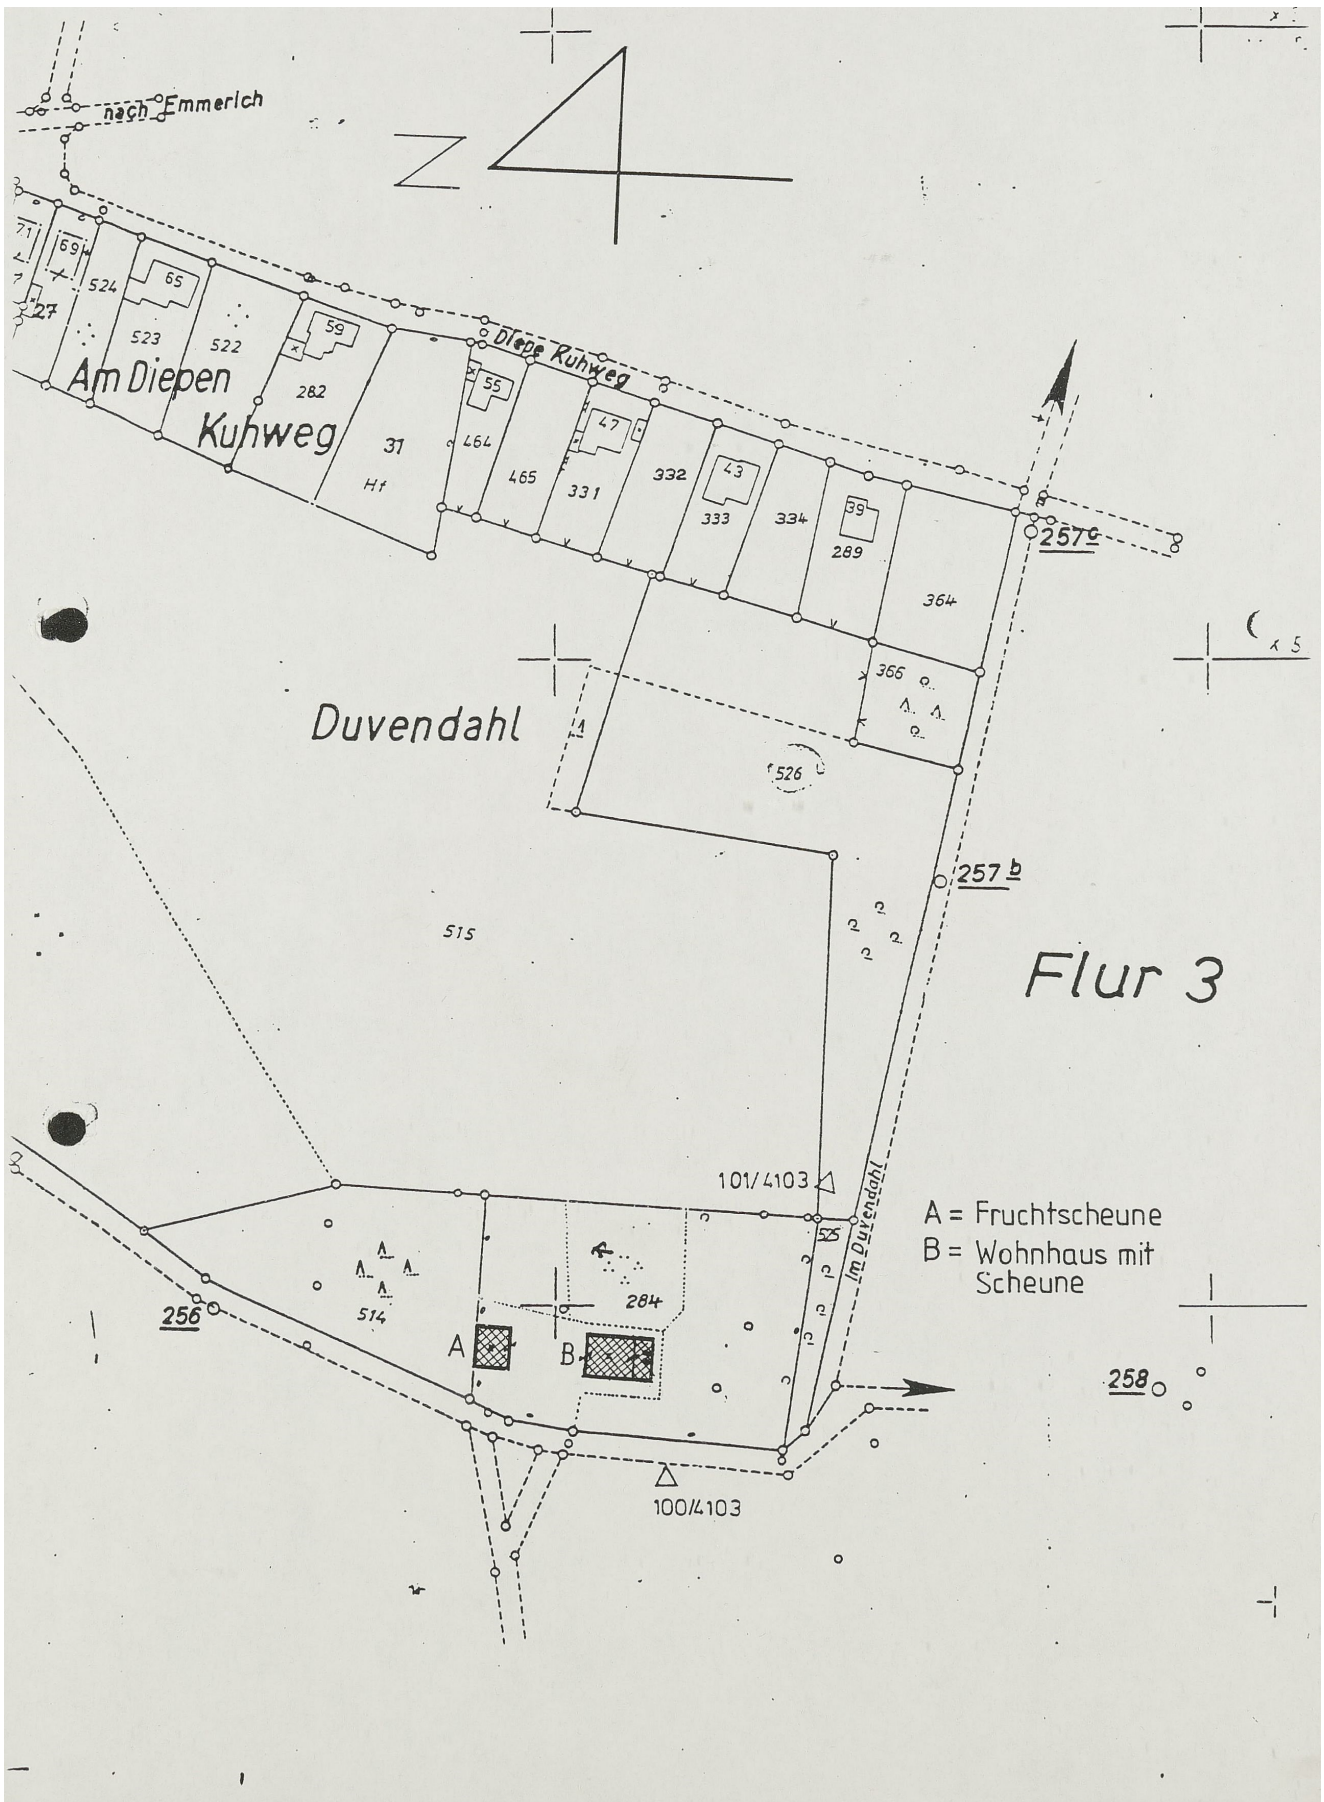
Lageplan Haus Duvendahl 20. Jh.
